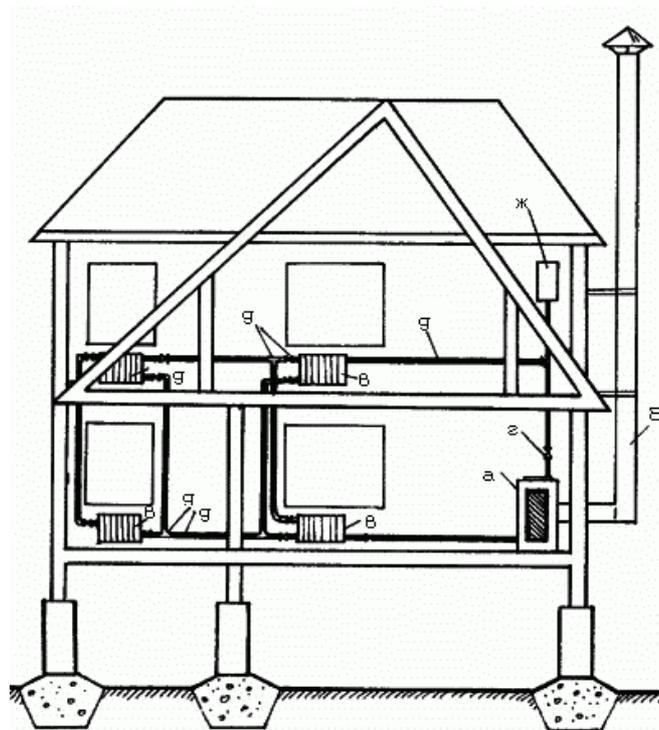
Схема системы автономного отопления на твердом топливе: а – котел КЧМ-5; б – дымоход эмалированный неутепленный; в – чугунные семисекционные радиаторные батареи; г – циркулярный насос «grundfos»; д – соединительные трубы и фитинги стальные неоцинкованные; ж – сварной металлический расширительный бачок
